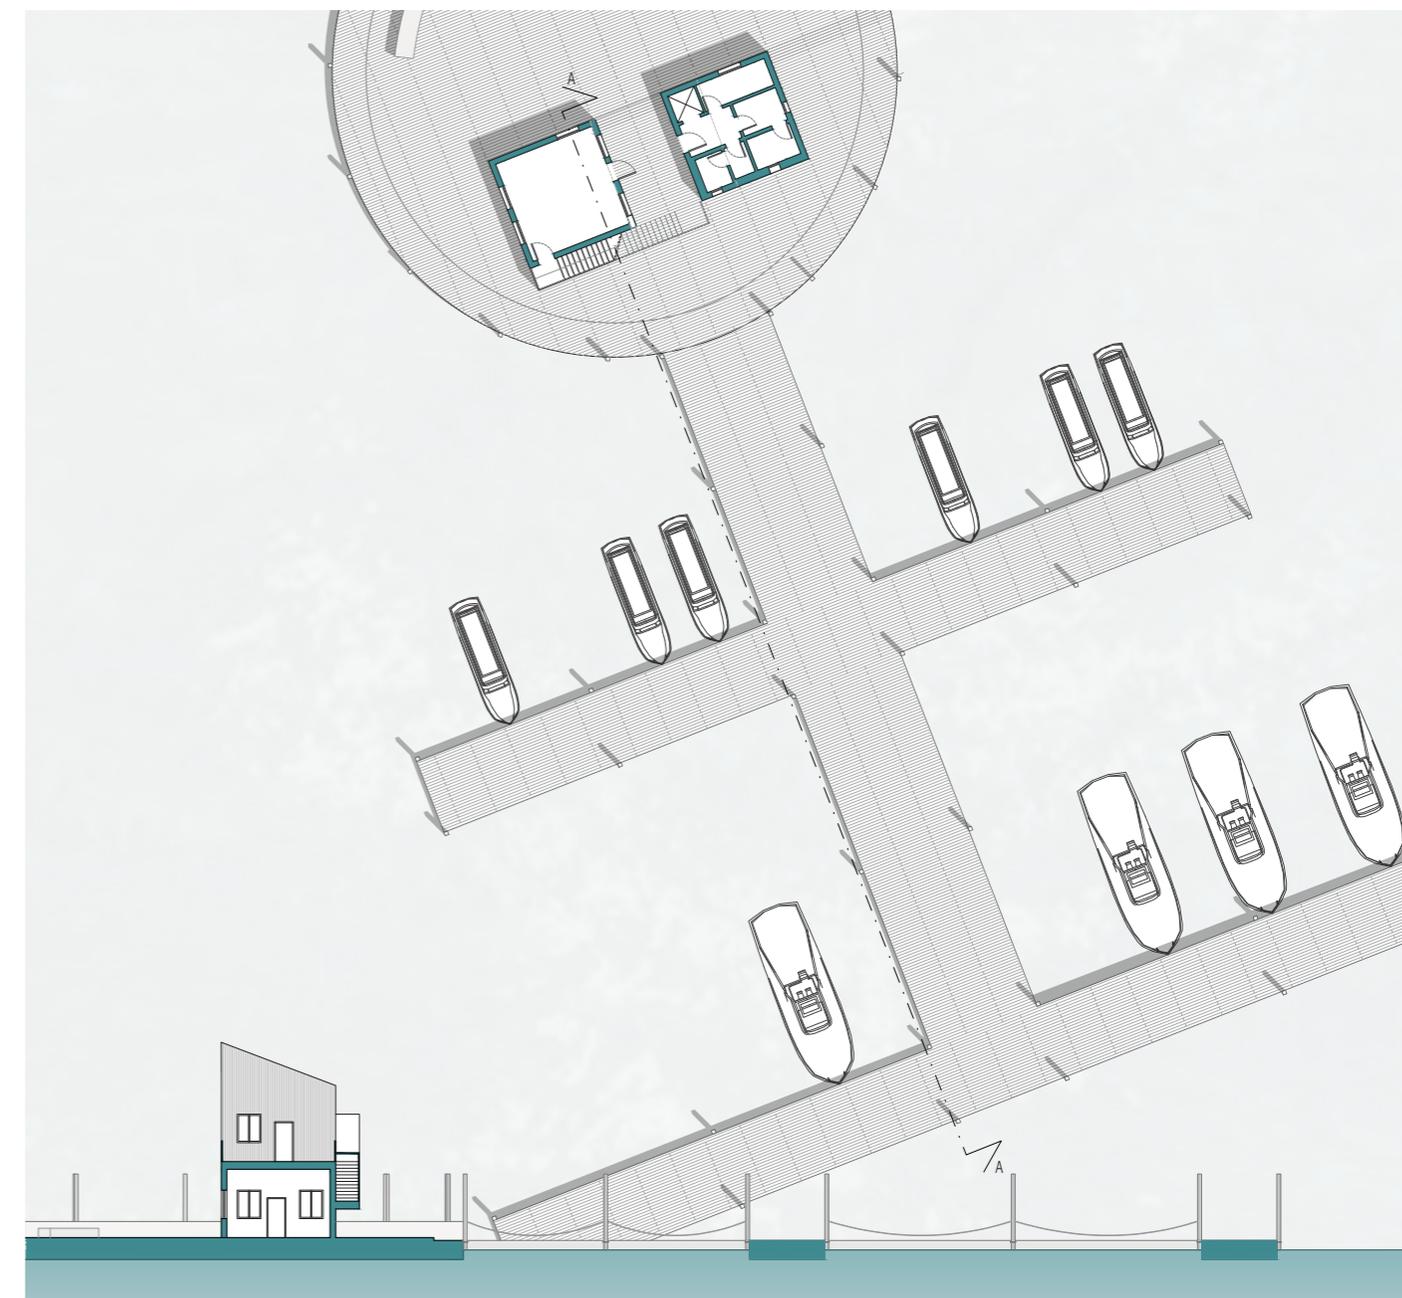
Planivolumetrico 1:1000 e distribuzione funzionale
